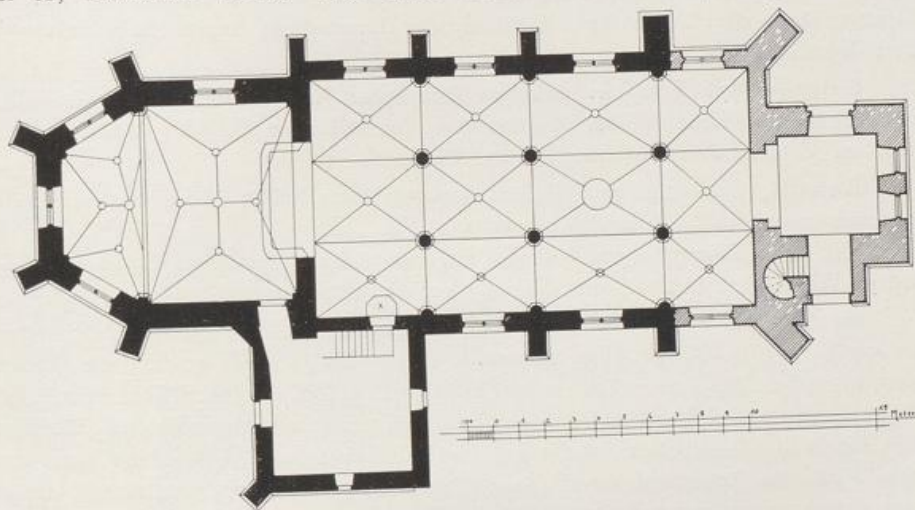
Binsfeld. Grundriss der kathol. Pfarrkirche.
